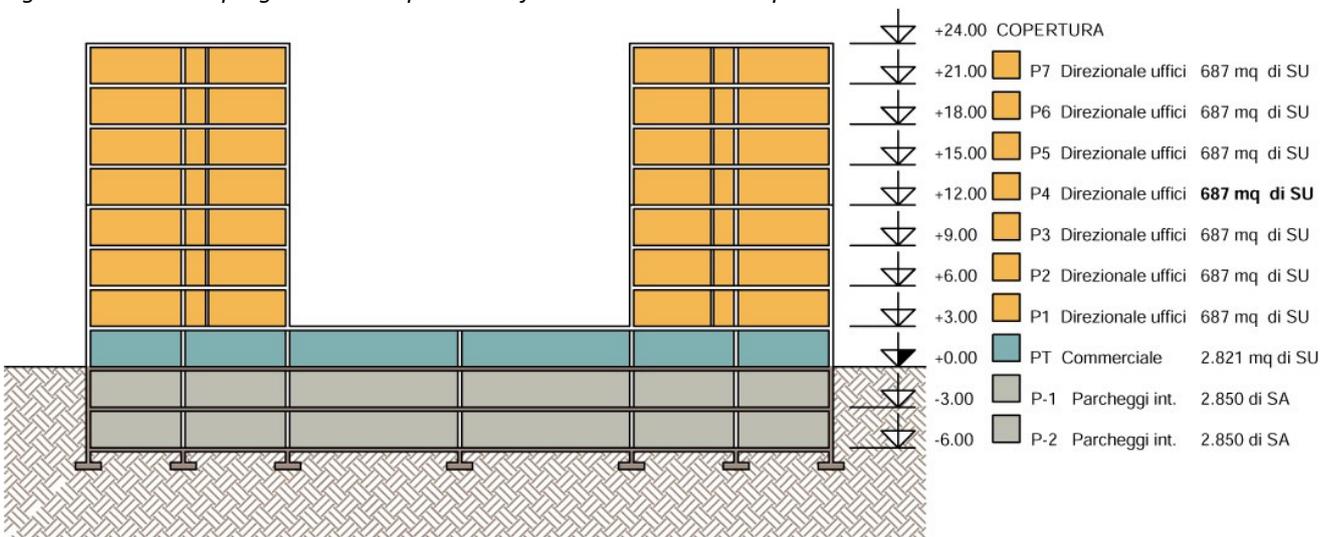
Schema progettuale dell'ipotesi trasformativa A - sezione tipo
